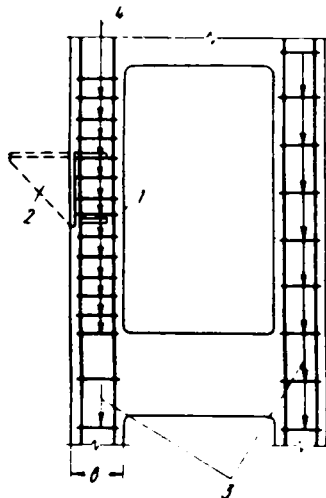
Деталь усиления ветви колонны высотой 14,4 м и более в месте установки столика для крепления панелей стен
